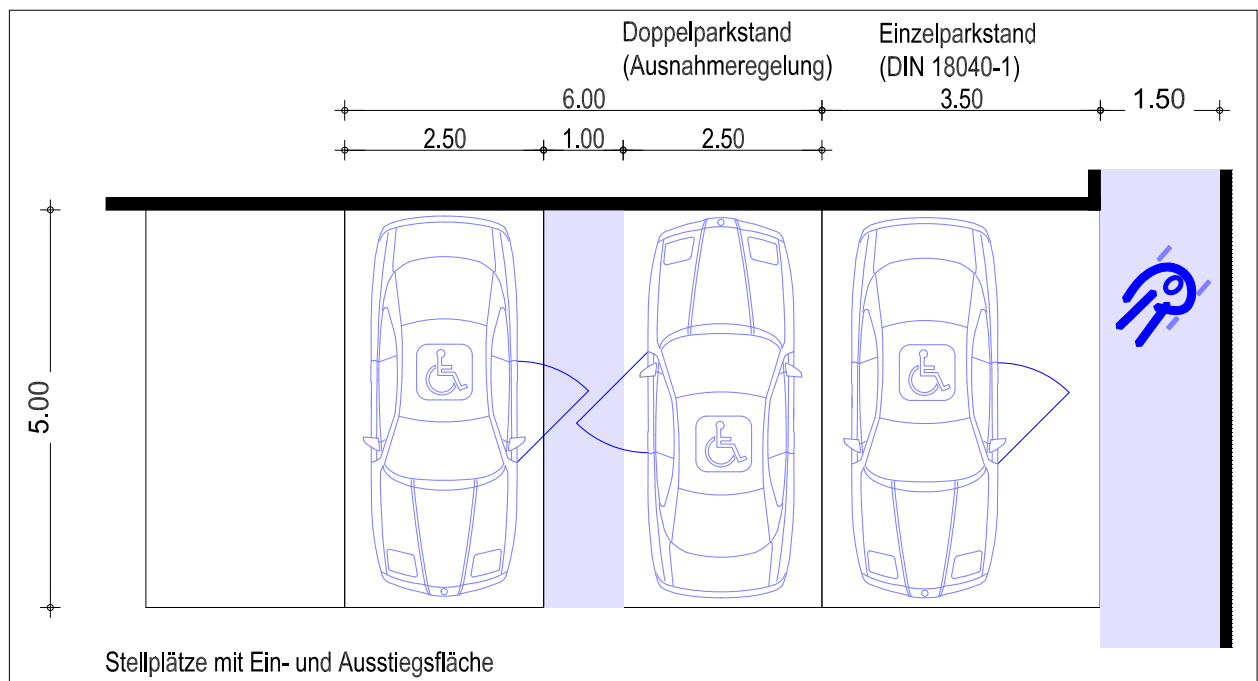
Parkplätze mit Ein- und Ausstiegsflächen, inkl. „Flächensparmodell“ (Doppelparkstand)
